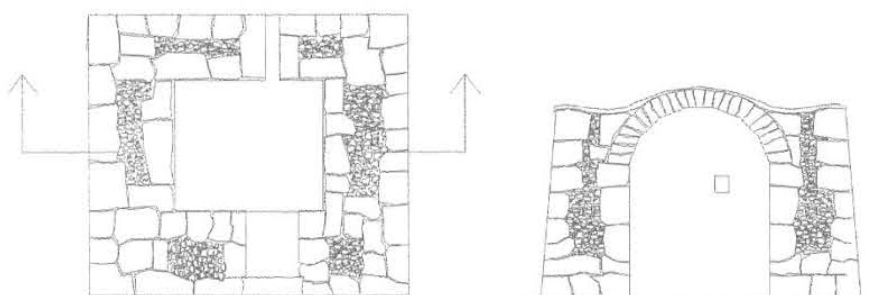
Planta e corte tipo de um *sardùni* (Farina, 2003 p. 73).
